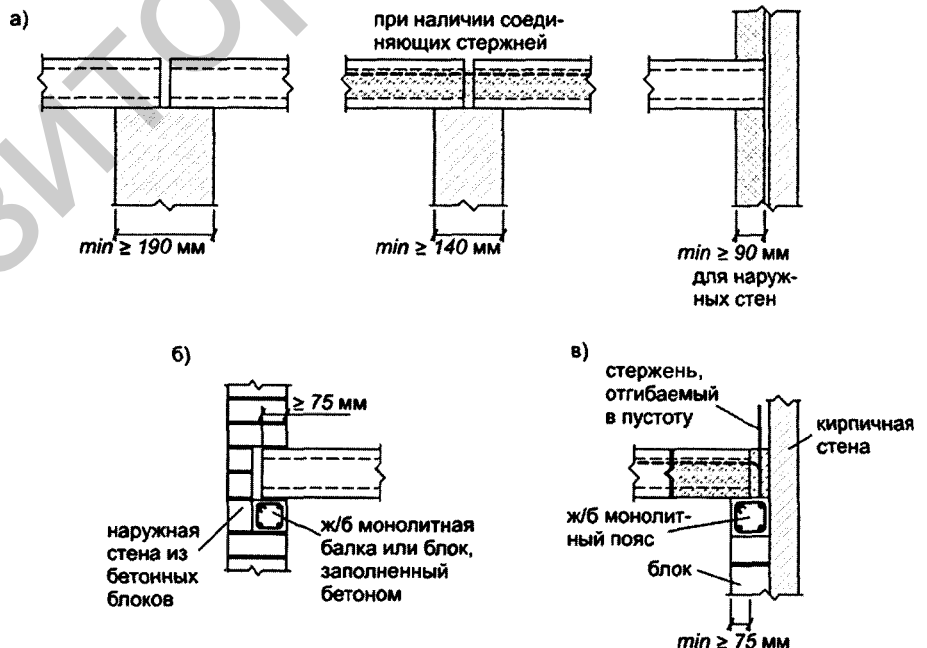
Схемы опирания плит безопалубочного формования согласно [10]: а — опирание на внутренние и наружные стены; б, в — опирание на железобетонную балку в наружной стене
